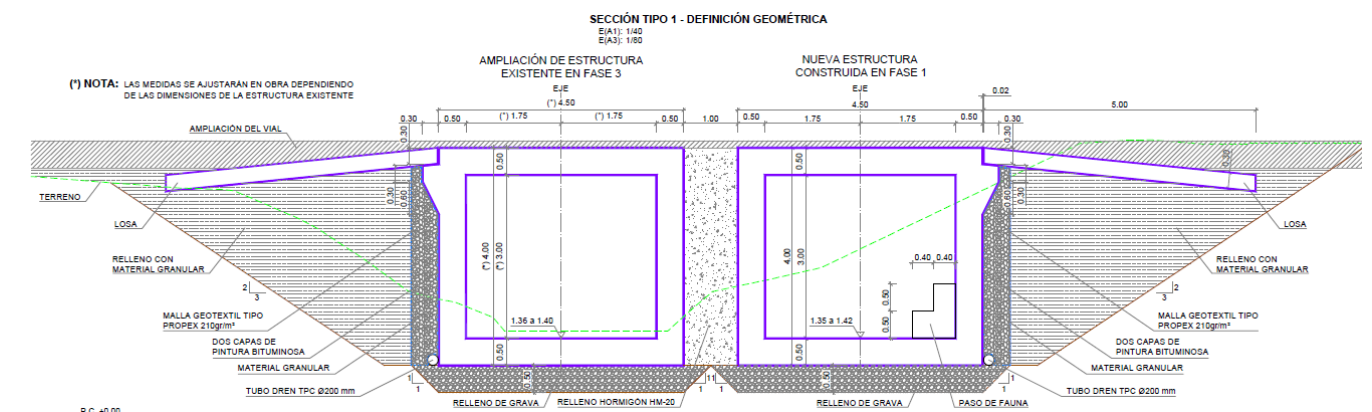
Sección transversal del drenaje proyectado para la regata Astierreka.
